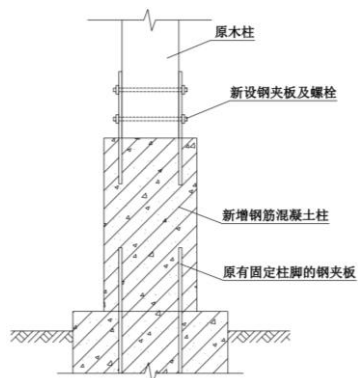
柱底钢筋混凝土柱置换、夹板及螺栓加固
